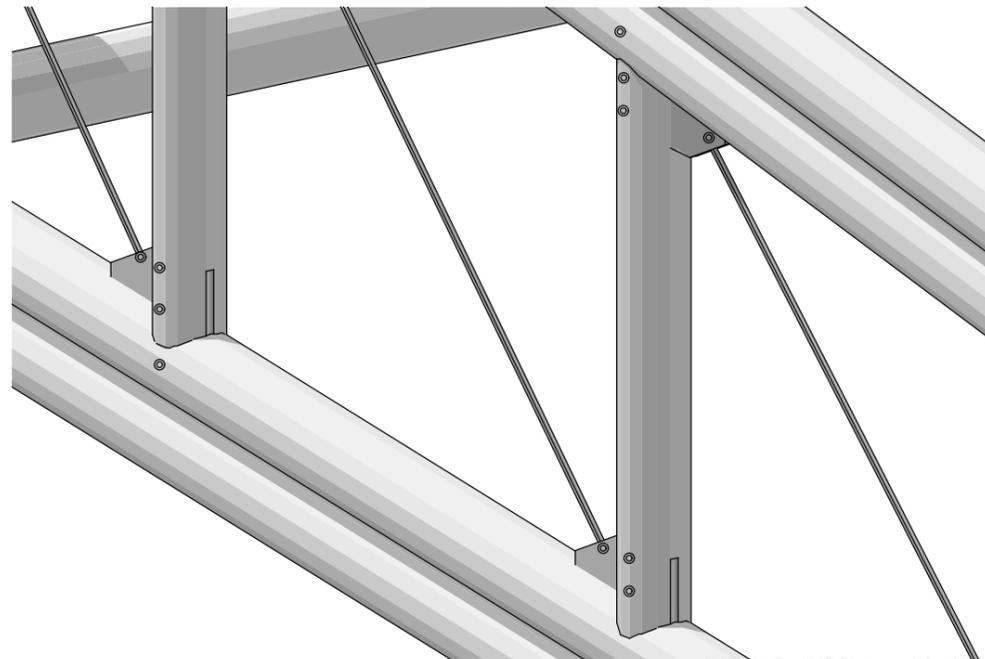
Detail 3D Bindung mit Stahlplatte
